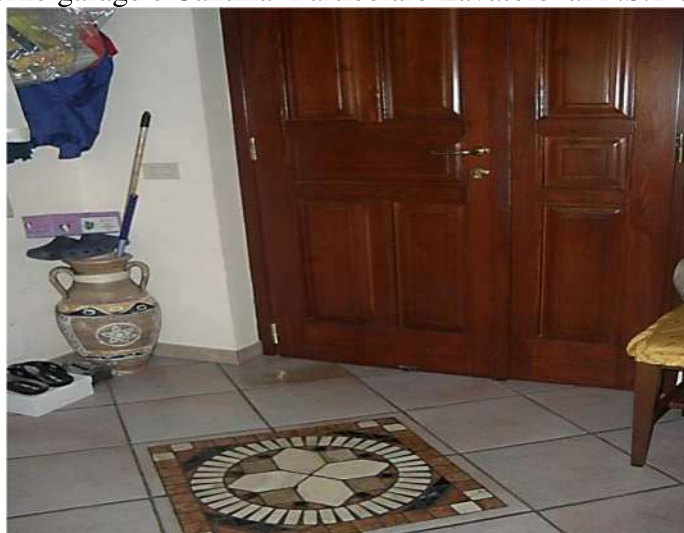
e 12 -Particolare Scala di collegamento Cantina con il P.T. -Particolare Ingresso al P.T. .
